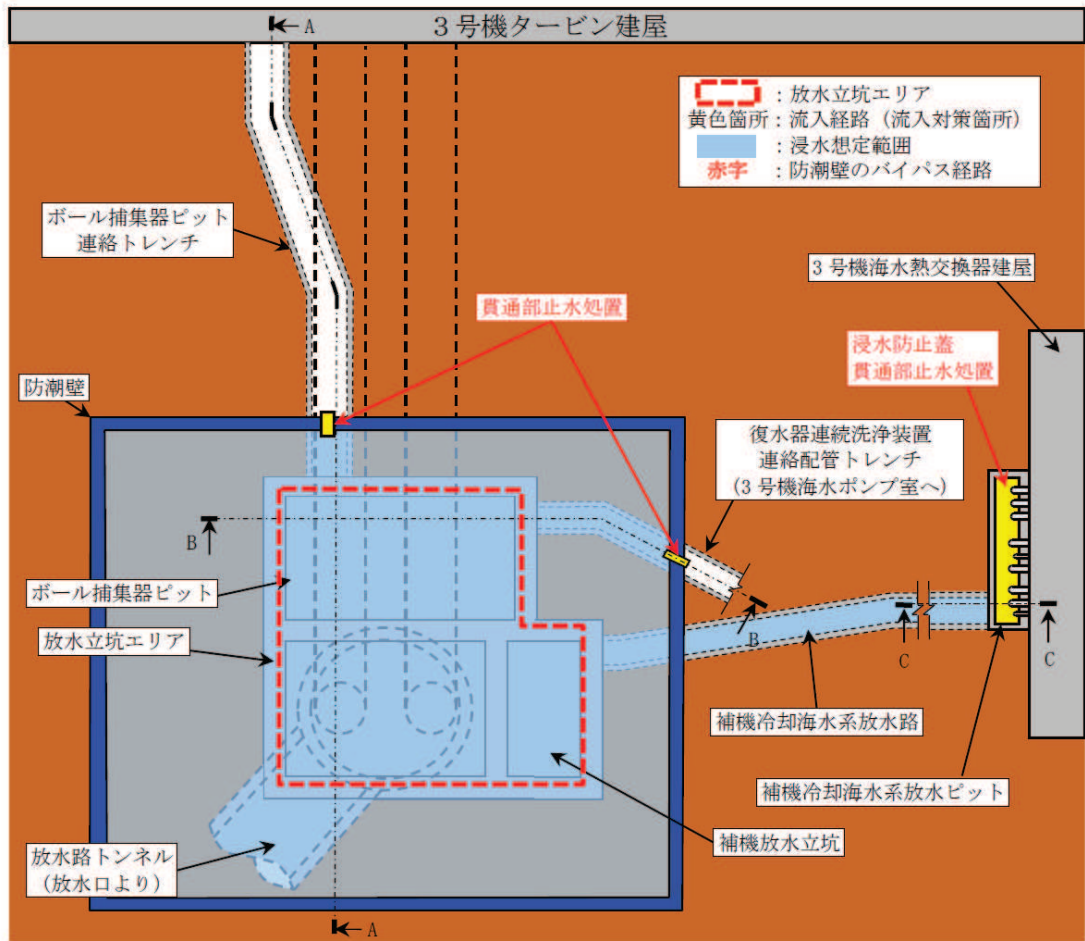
第 3 号機 放水立坑 流入対策配置図 (平面図)
